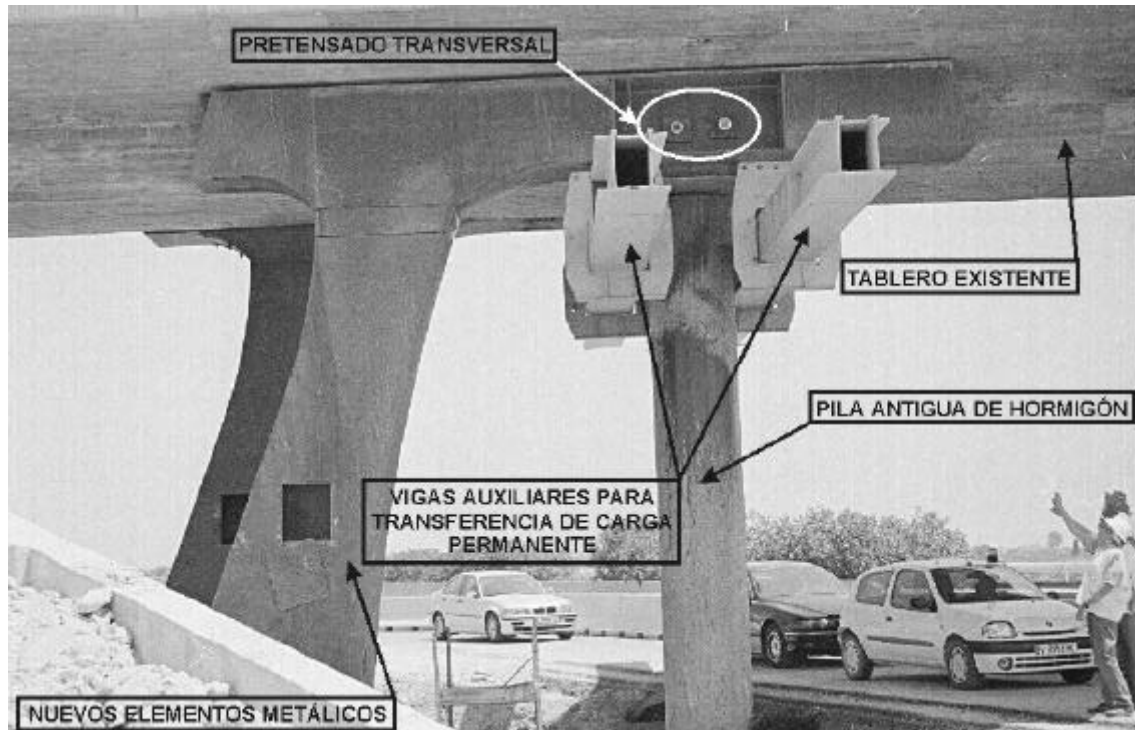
Fase del proceso constructivo previo a la eliminación de la pila antigua de hormigón.
